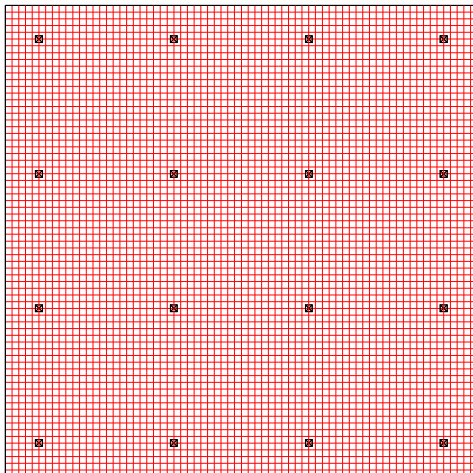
Alternativa de traçado 3 dos cabos no pavimento com balanço
